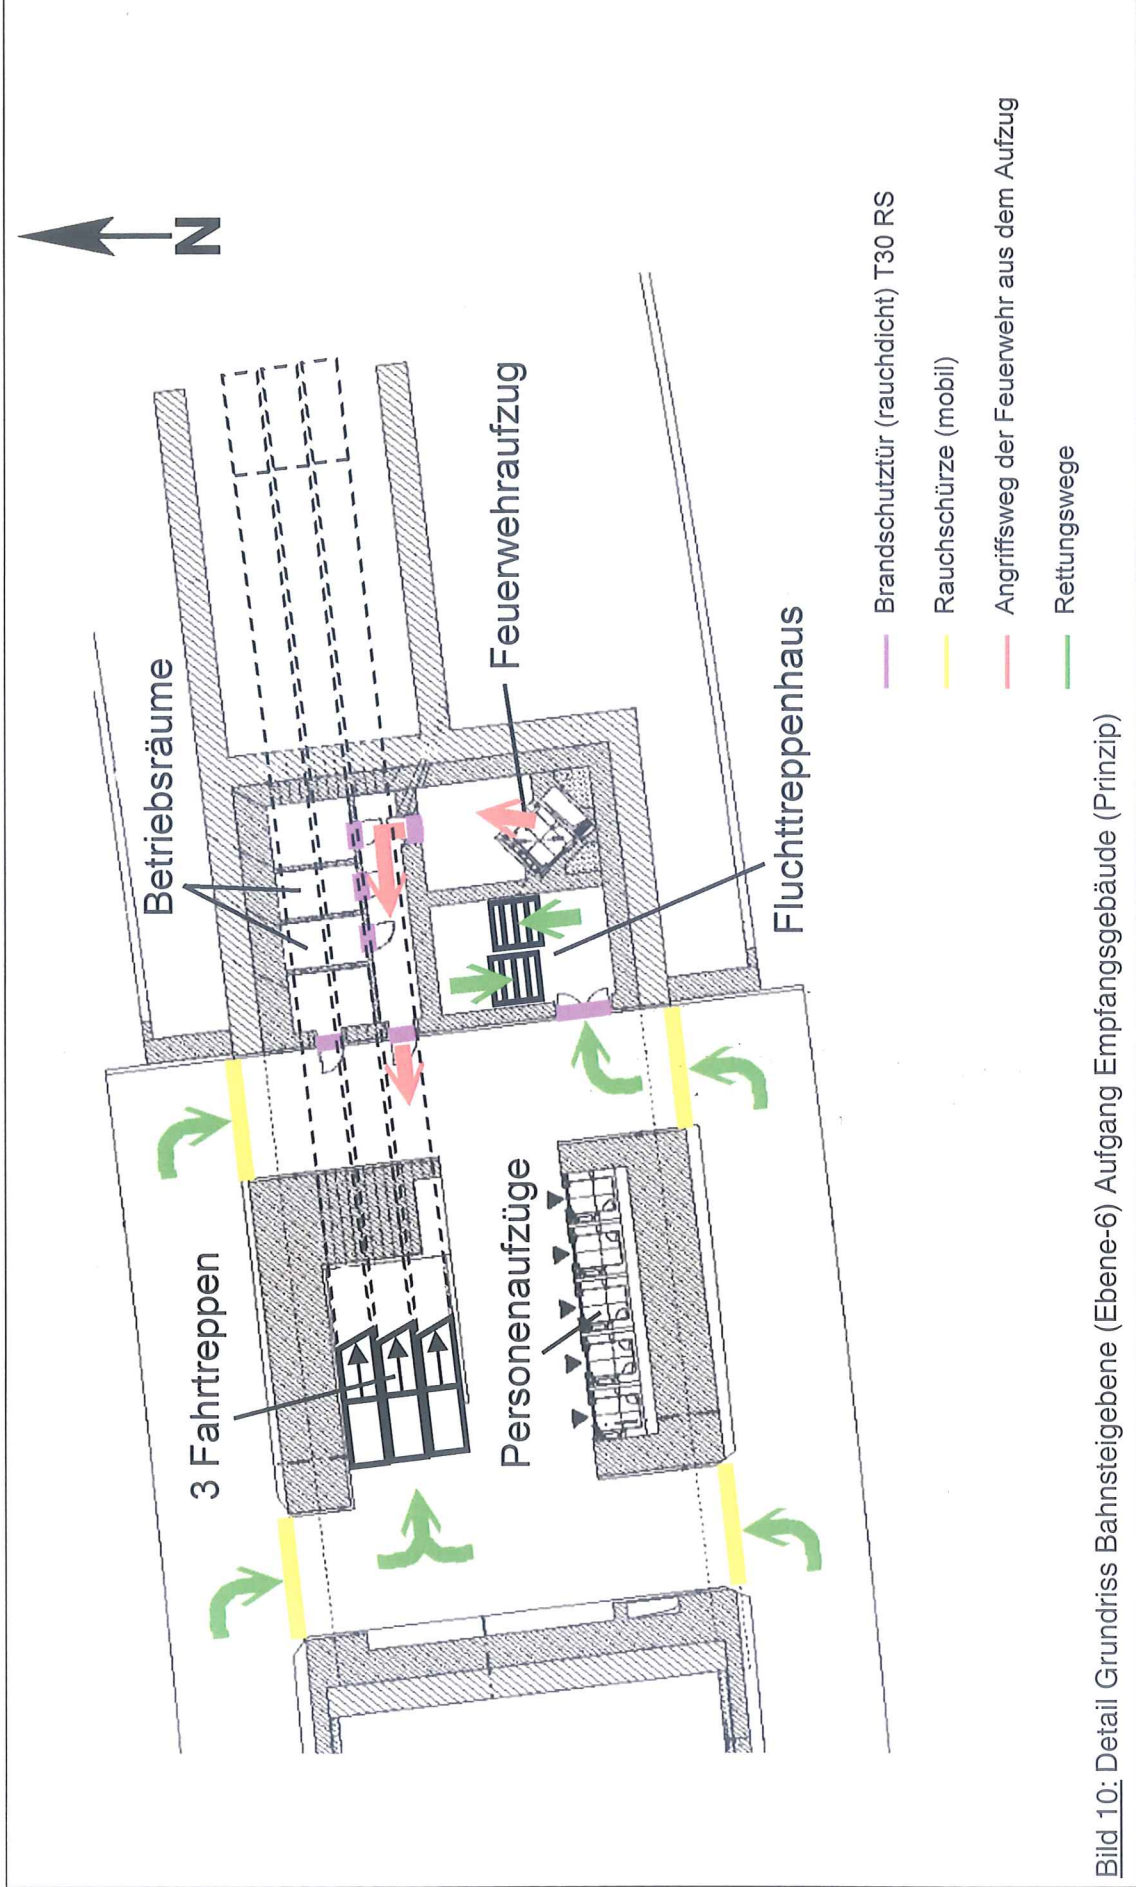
Detail Grundriss Bahnsteigebene (Ebene-6) Aufgang Empfangsgebäude (Prinzip)
